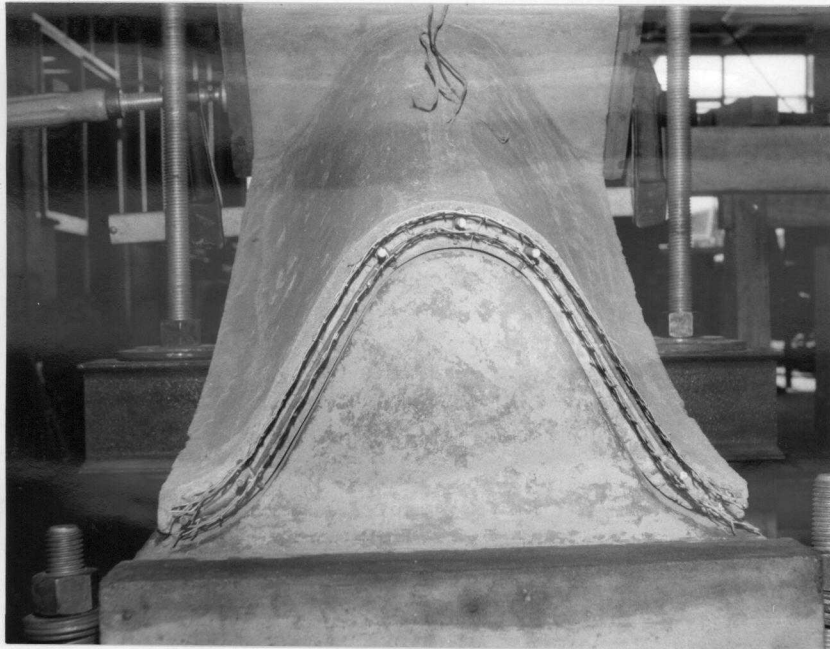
Construção da nervura de apoio - posicionamento da peça.
